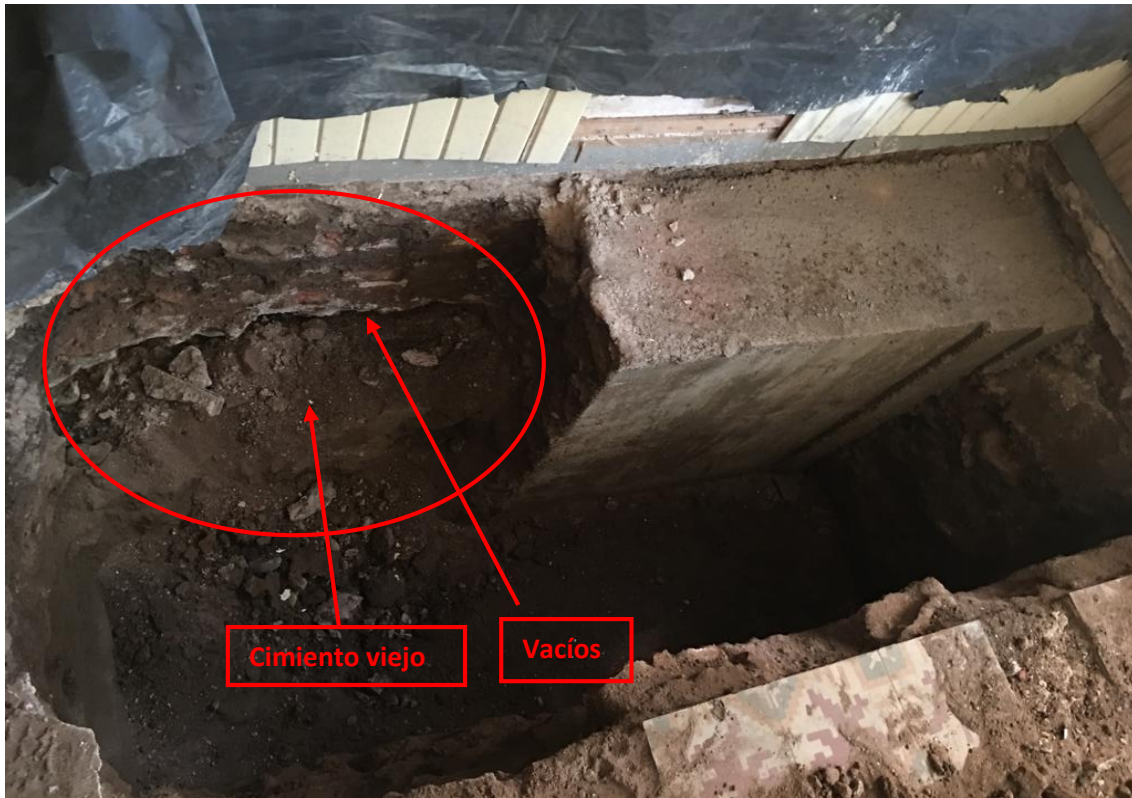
Submuración en esquina. Recalce entre cimiento y muro medianero
